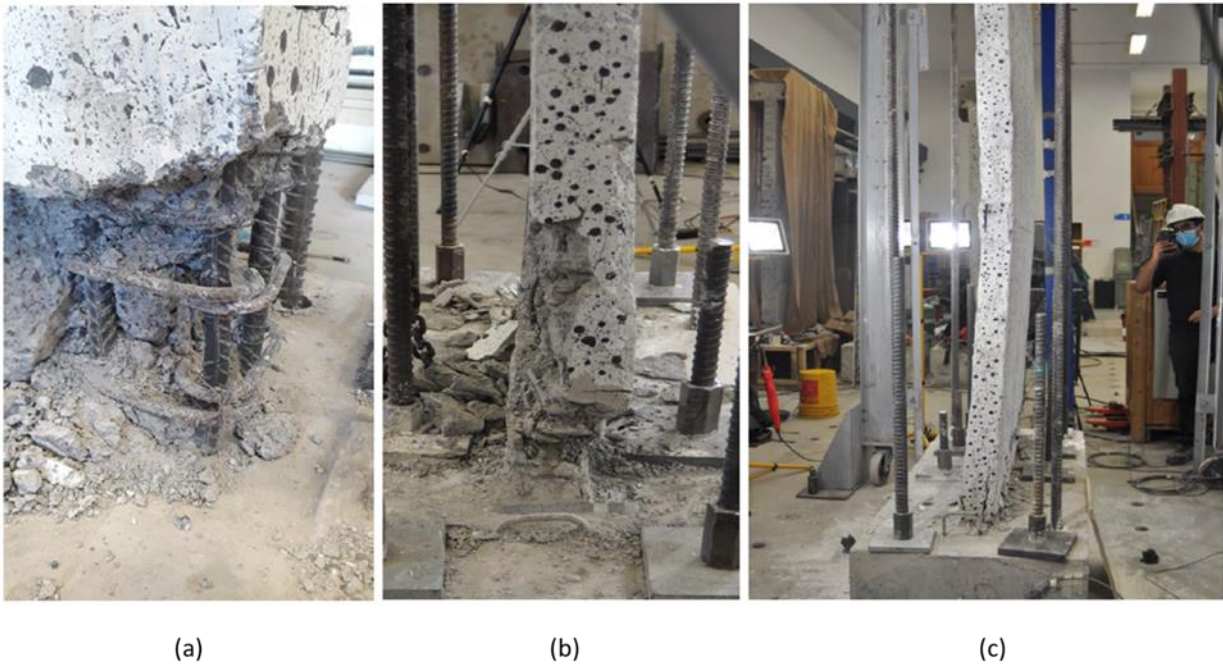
Tipos de daño observado en las diferentes probetas al momento de la falla. Muro M1 (a); Muro M2 (b); Muro M3(c) (adaptada de Jara [22]).
